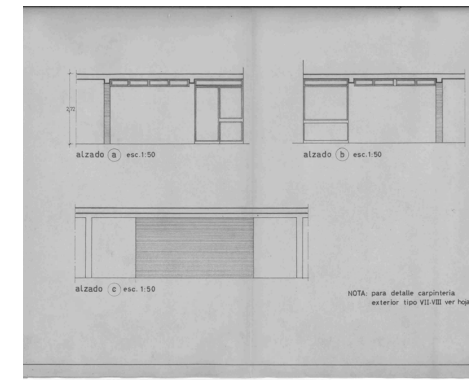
Plano alzados tipo vivienda unifamiliar.
